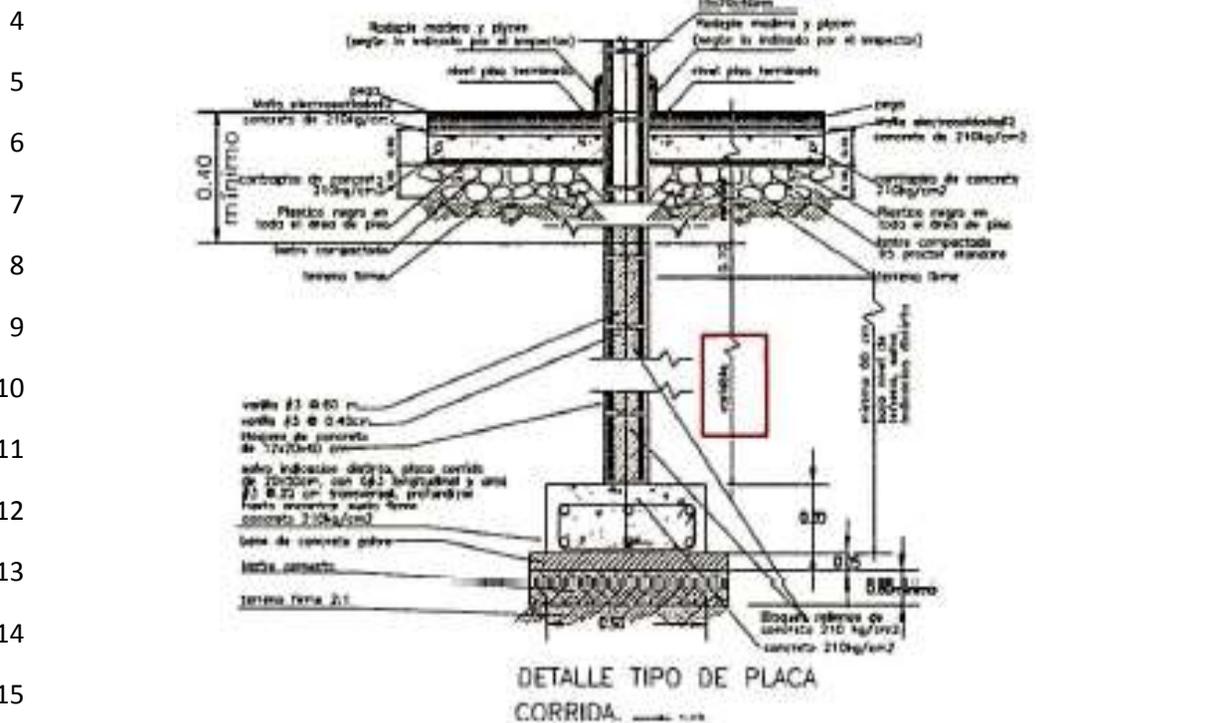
Izquierda: Detalle de cimientos (Fuente: de lámina N° 13 de planos constructivos).
